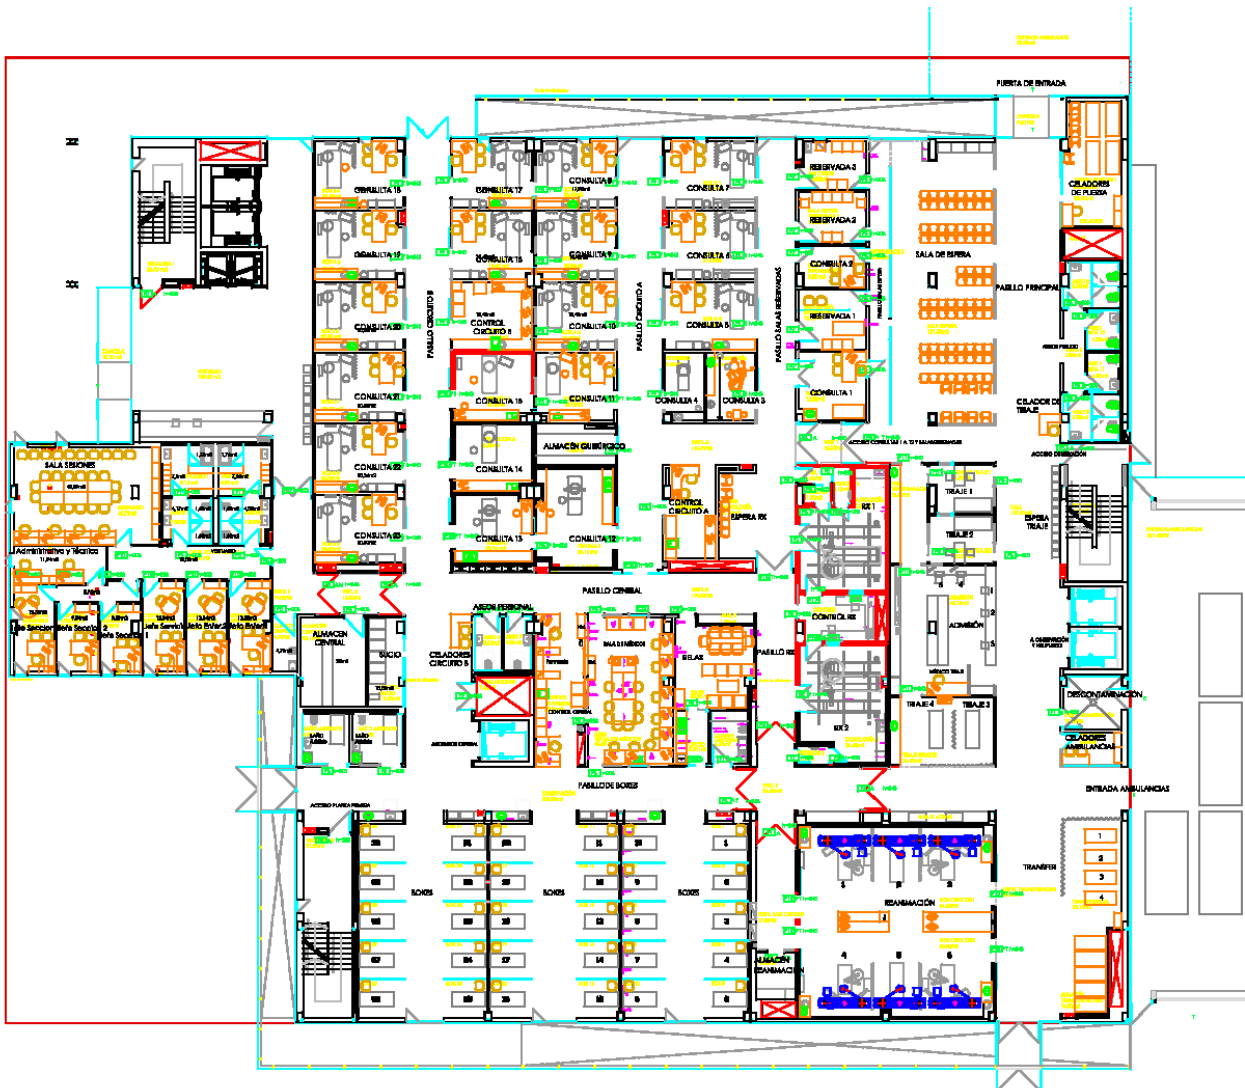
Plano de la planta baja del edificio (para más detalles acudir a la pag. )
